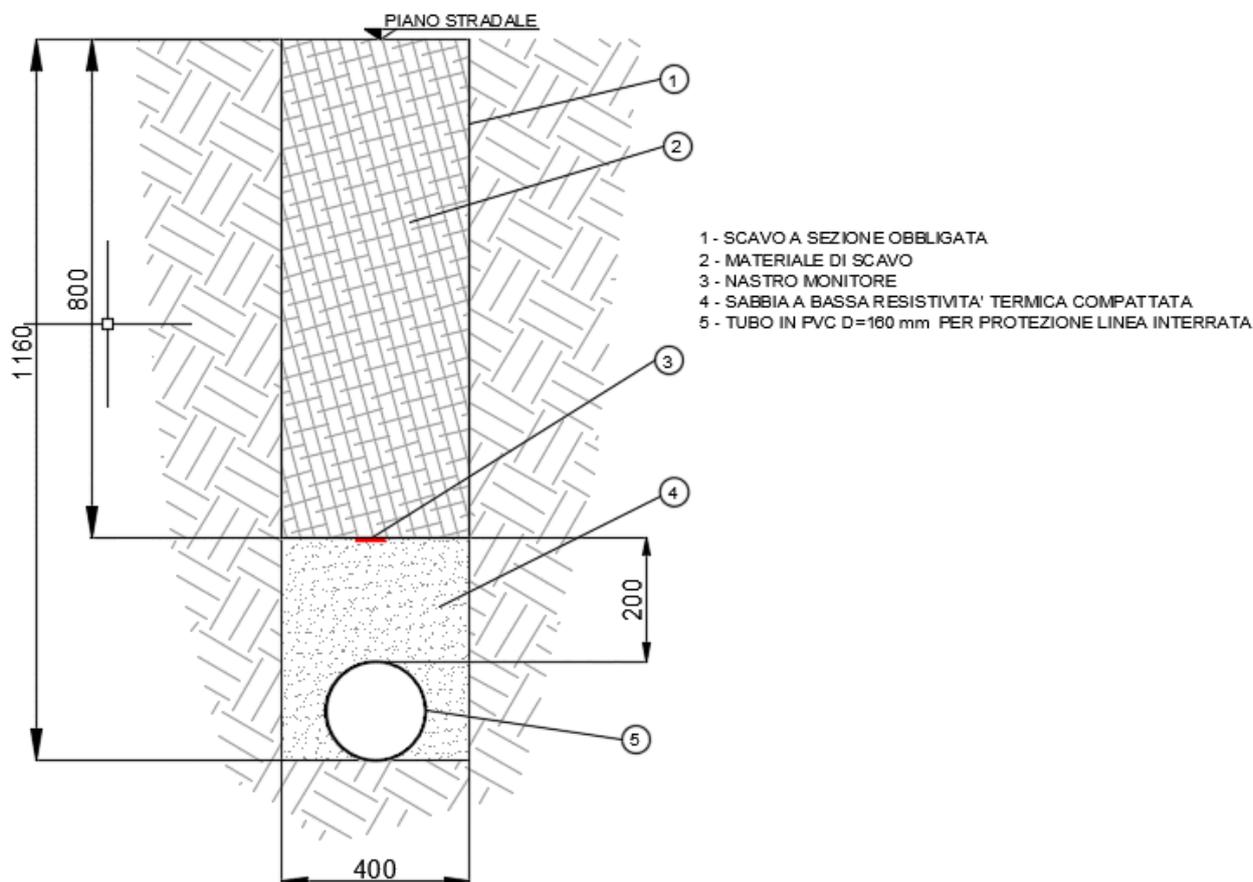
Tipico posa cavidotto interrato MT con protezione meccanica in PVC
